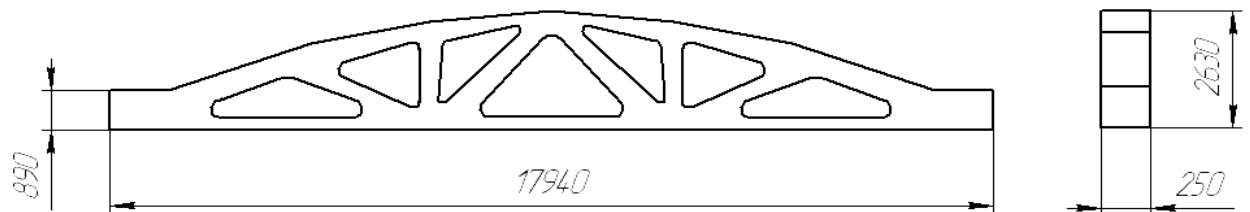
Железобетонная ферма серии 1.462-3
